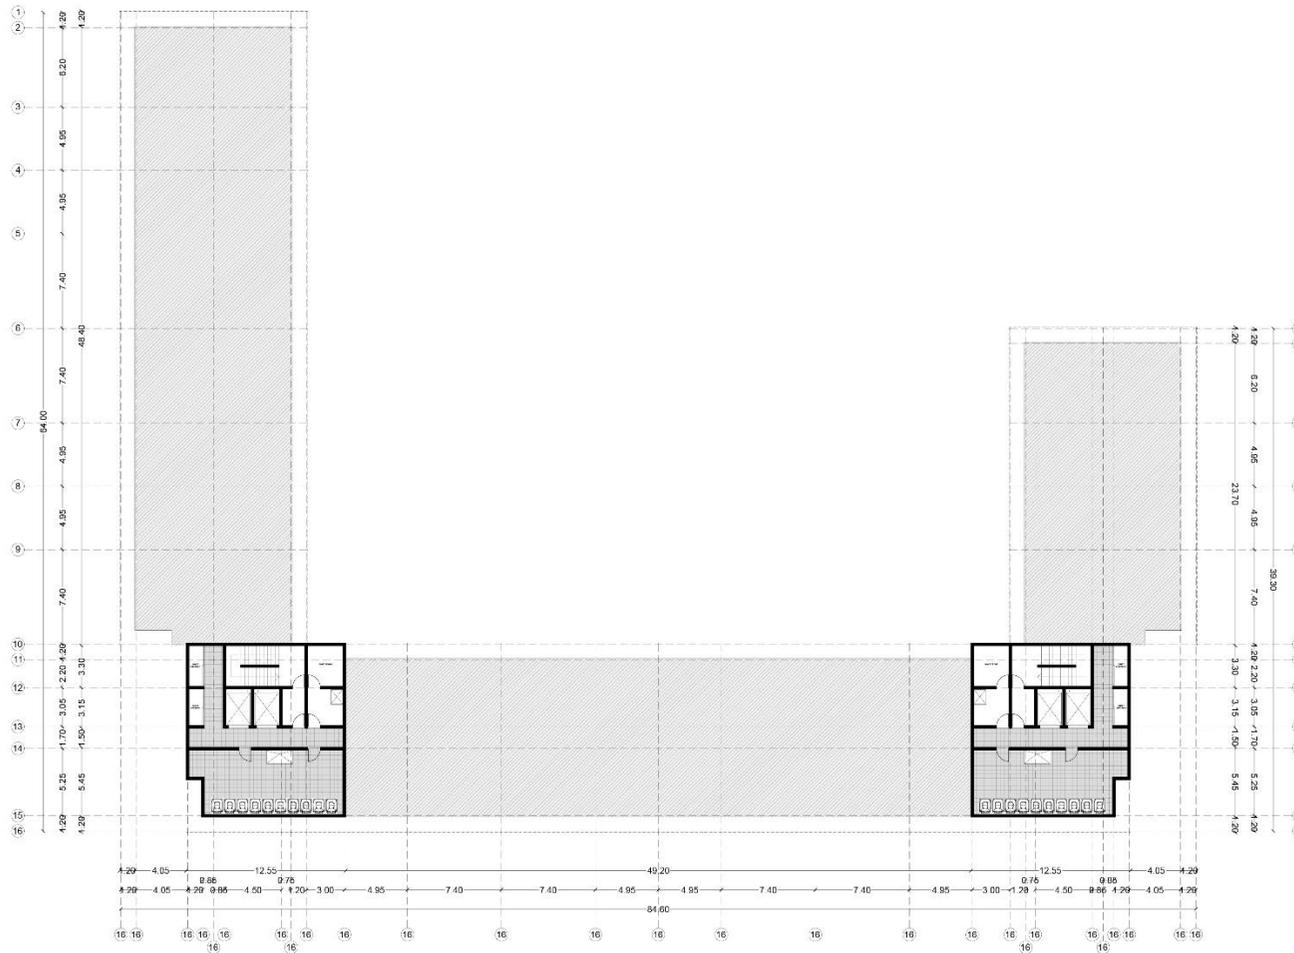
Planta -1° edificio 6/8 pisos, escala 1/300. Fuente: Elaboración propia.
